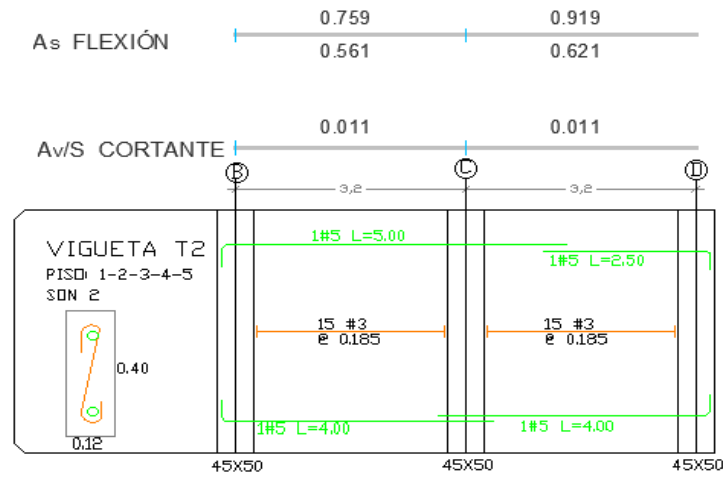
Cuantías obtenidas por esfuerzo a flexión, cortante y despiece de la vigueta tipo 2 de la planta estructural. Fuente: elaboración propia.
